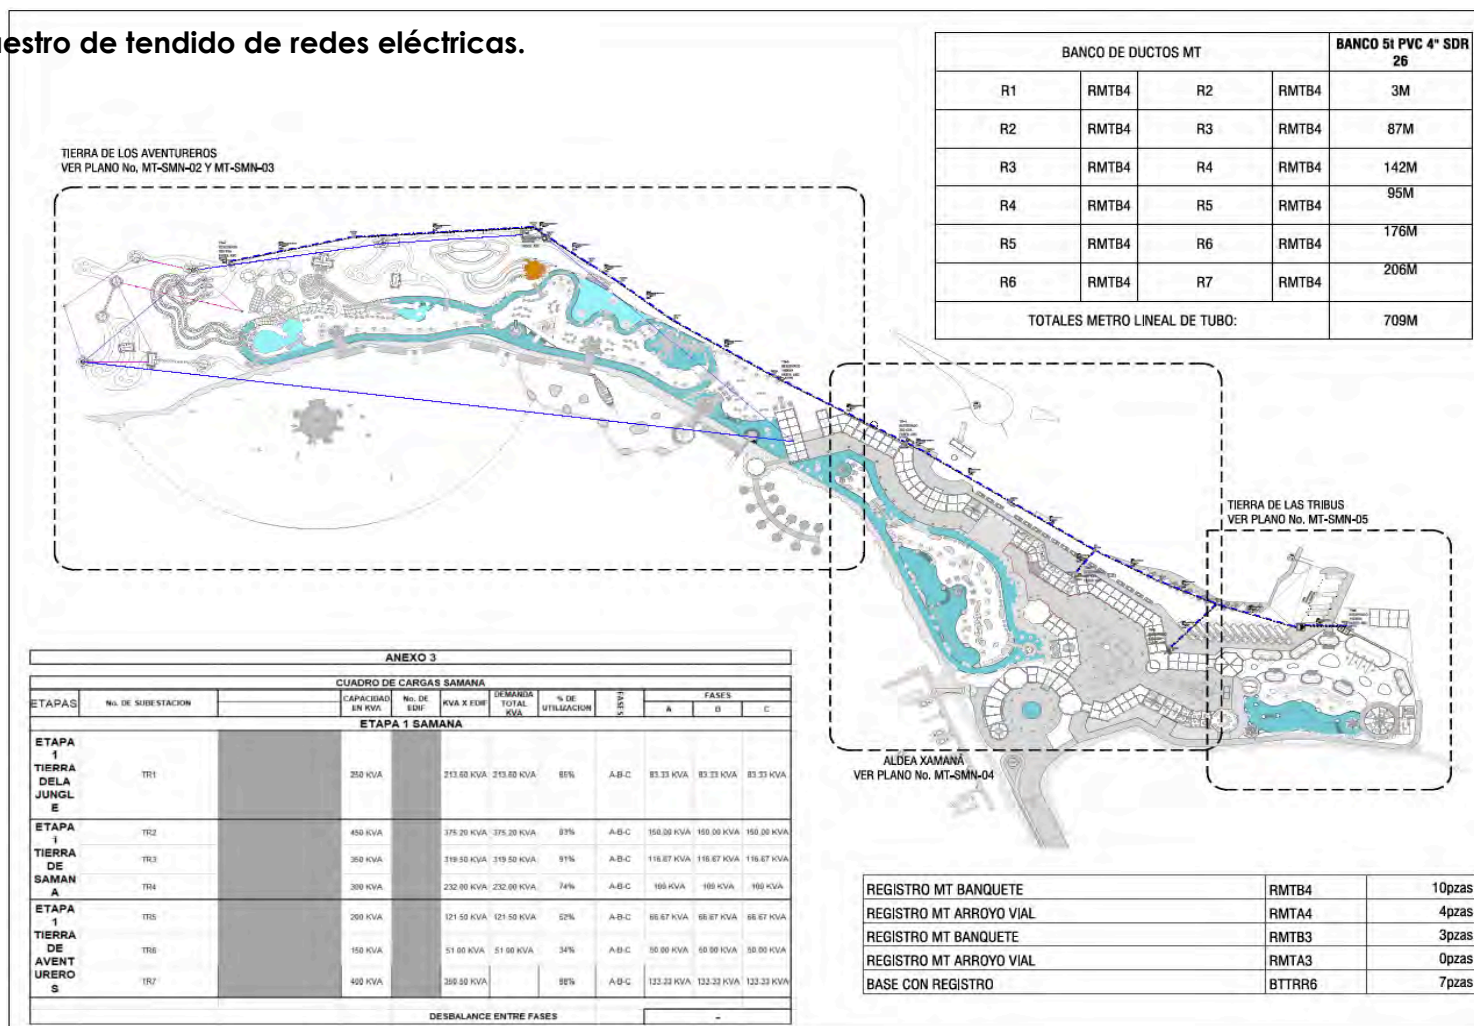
Plano de redes eléctricas al interior del proyecto.
